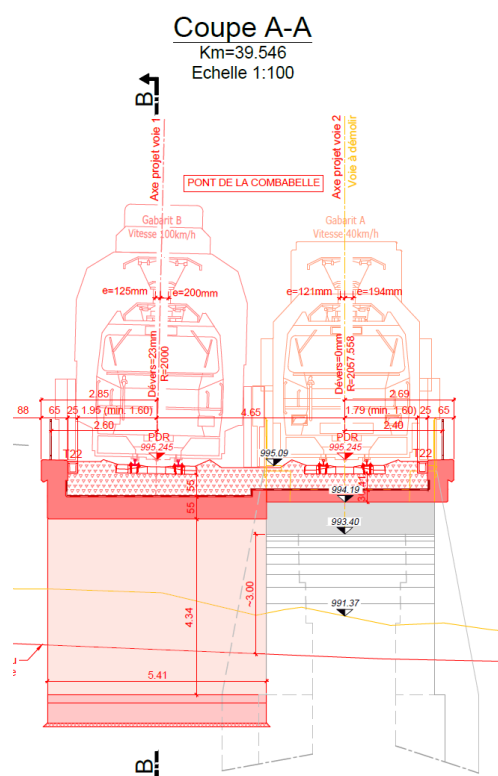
Coupe dans le pont de la Combabelle - extrait de plan
